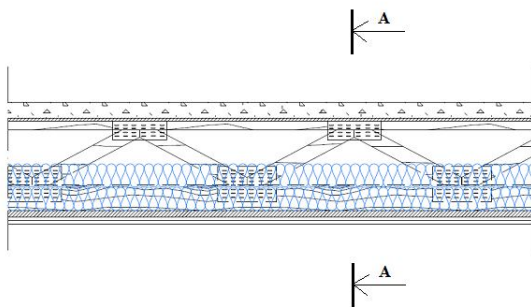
Фермы в перекрытиях SEPA 2000 / Farms in the ceiling SEPA 2000
